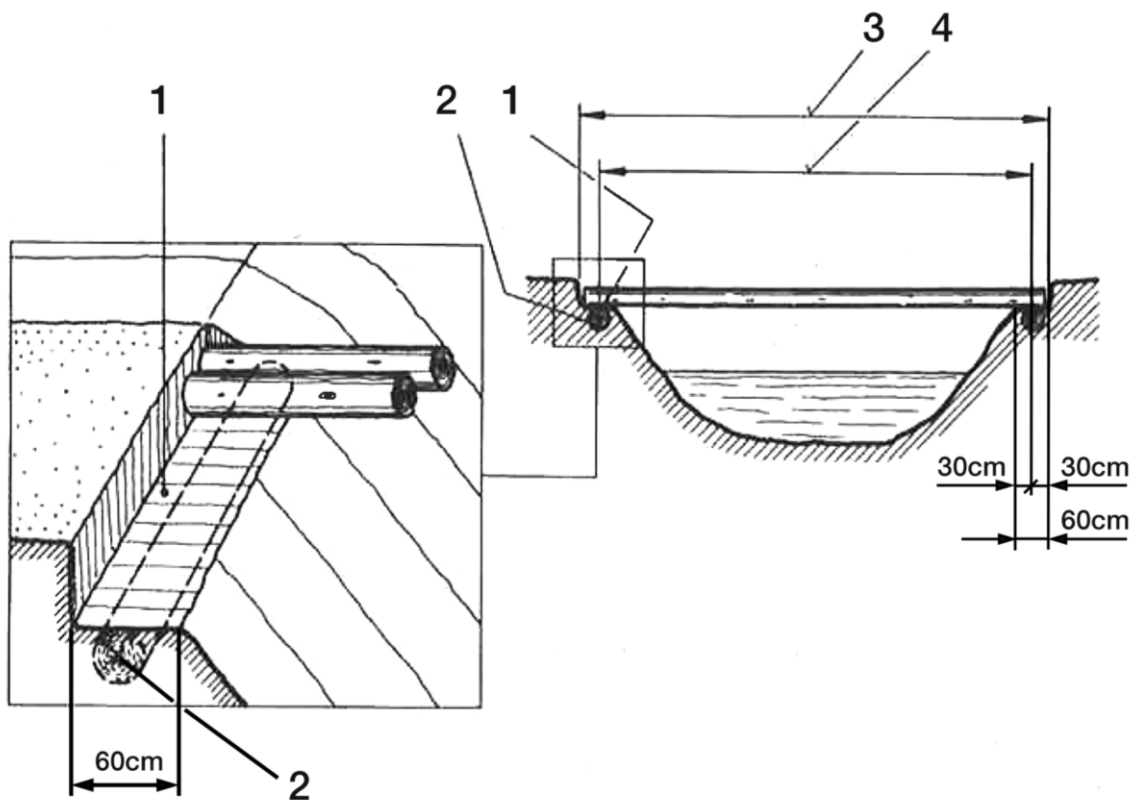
Detail Auflager/ Brückenlänge, Spannweite
